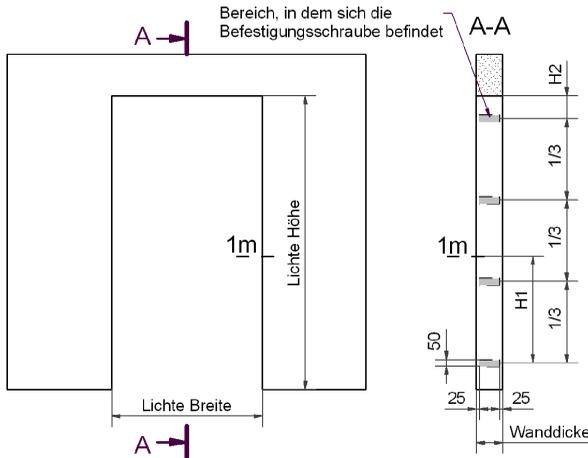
Maßskizze der Befestigungsbereiche für Schrauben bei Blockzargen
